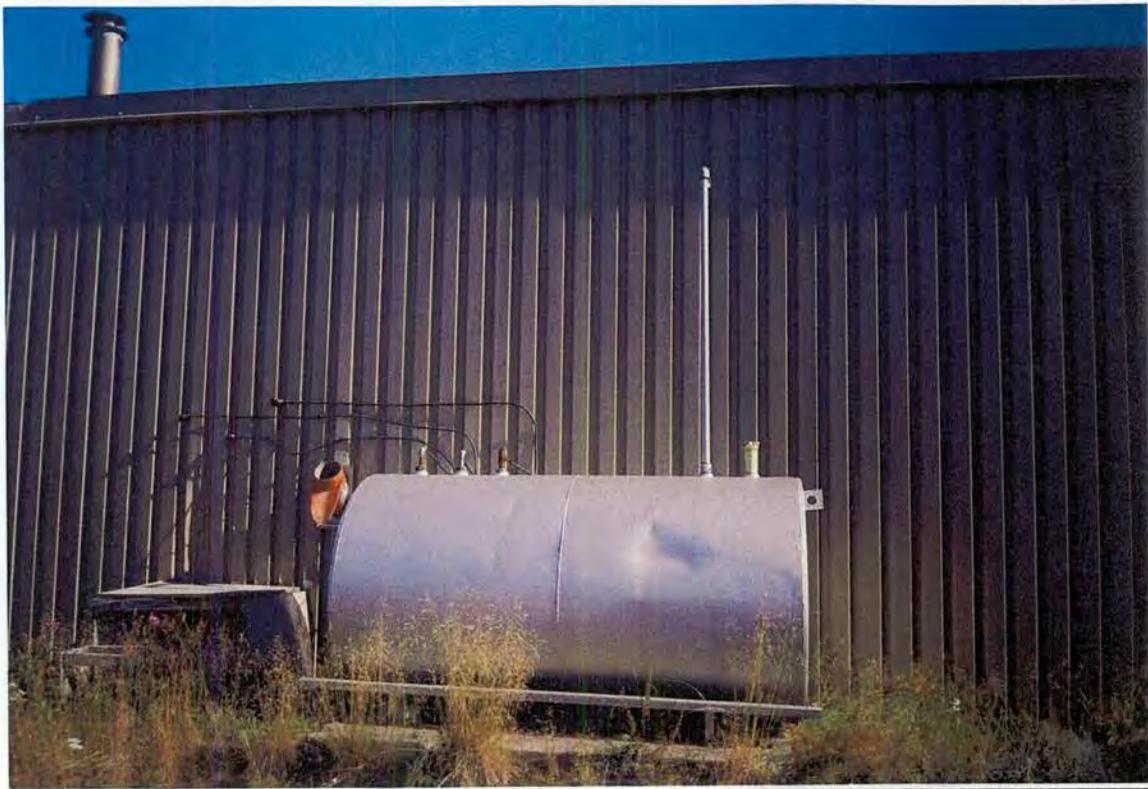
Réservoir de mazout 2 273 litres (T-161).
